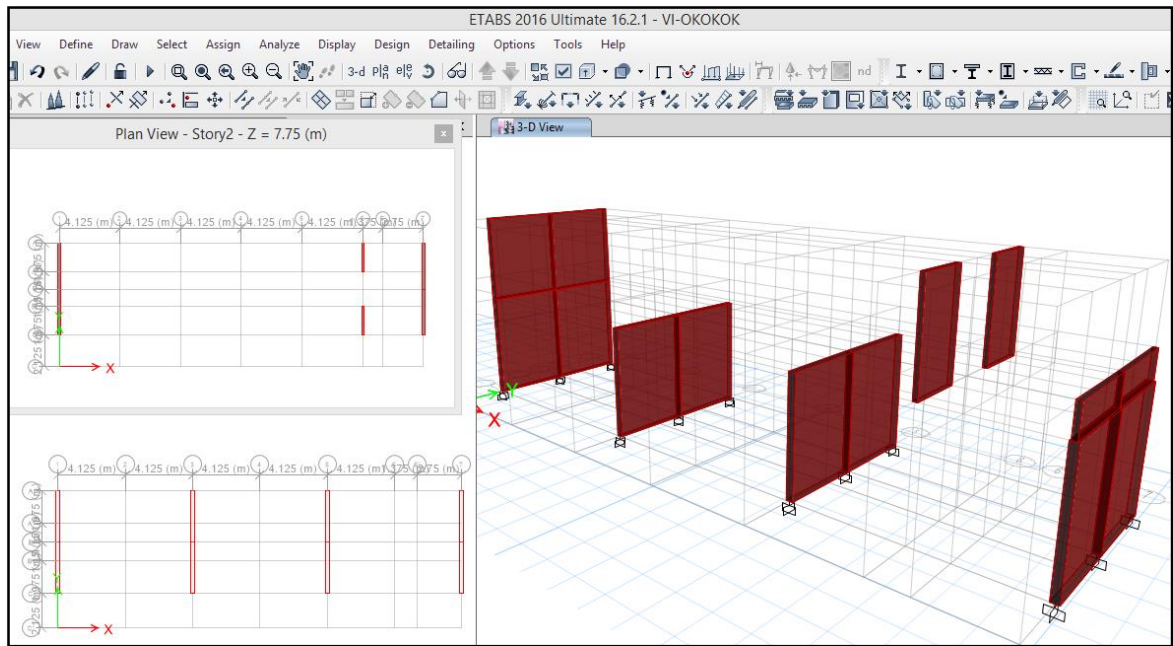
Dibujo de todas los muros de albañilería del sistema estructural del módulo VI.
